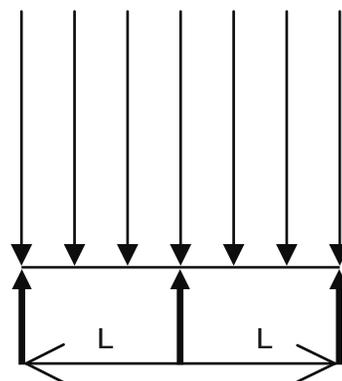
, Таблица 5. Нагрузки на кровельные панели с минераловатным утеплителем при схеме нагружения — статически неопределяемая двупролетная балка.
